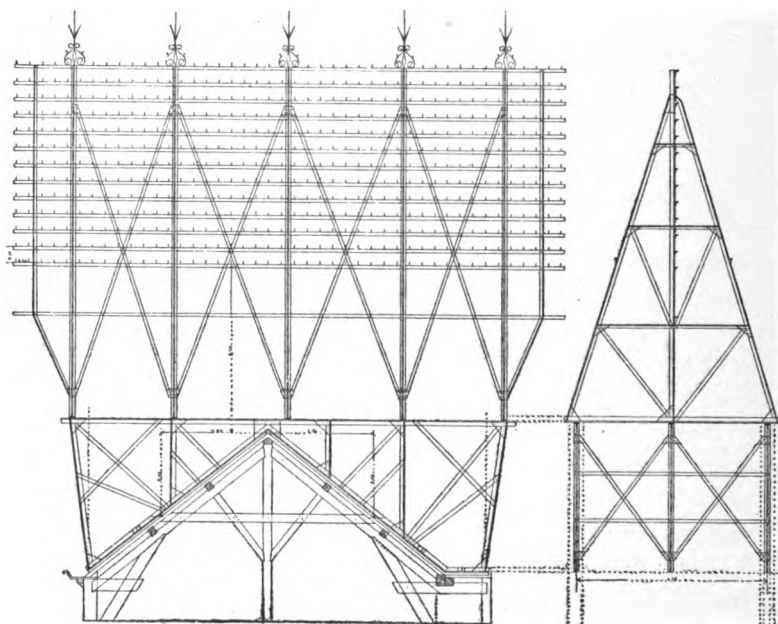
et 7. — Chevalet (fils parallèles au faite de la toiture).
